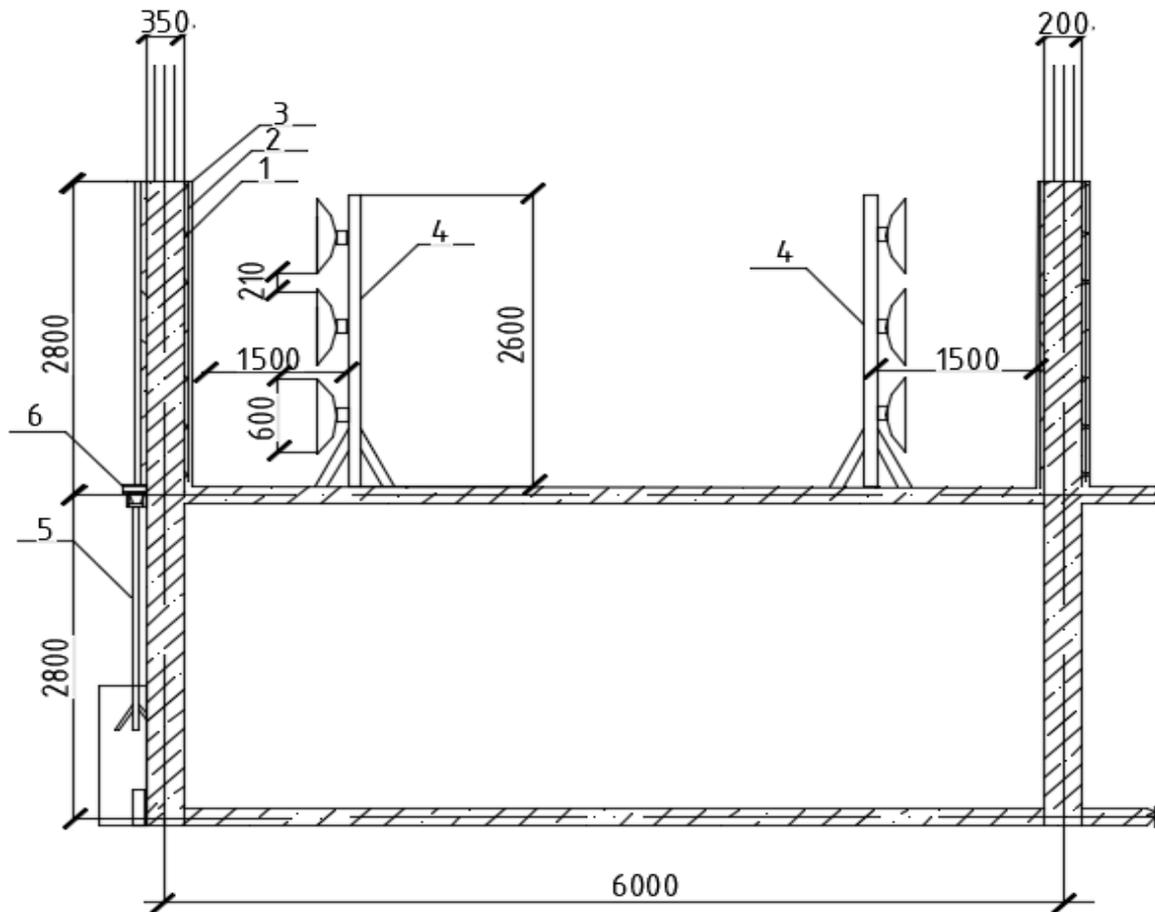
Схема теплообработки наружной стены и внутренней несущей стены в бескаркасном монолитном жилом доме: 1 – бетонная стена с армированием; 2 – металлическая опалубка; 3 – чехол для защиты от чрезмерной потери влаги; 4 – установка ИК-излучения с параболическими отражателями; 5 – телескопическая стойка; 6 и 7 – деревянные балки для поддержания опалубки
